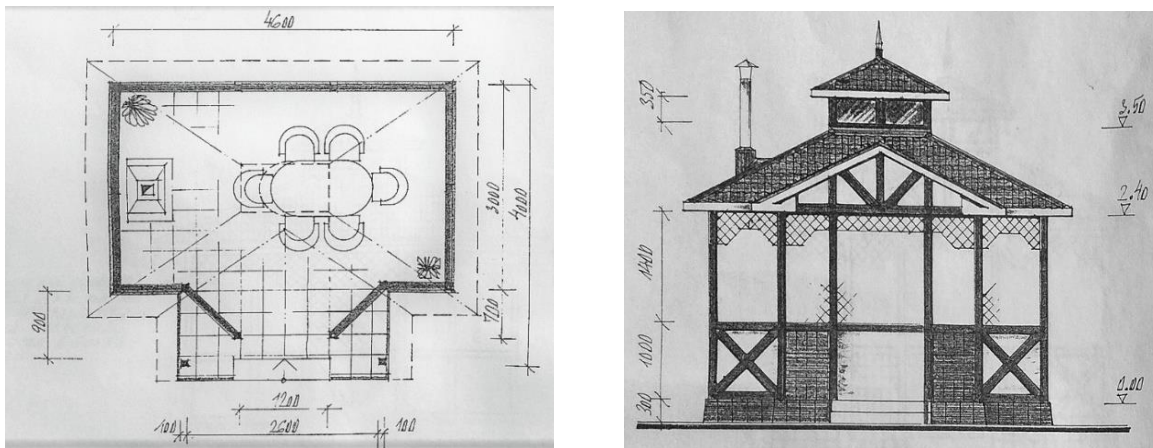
План и разрез ныне существующей беседки, до начала ее реконструкции
